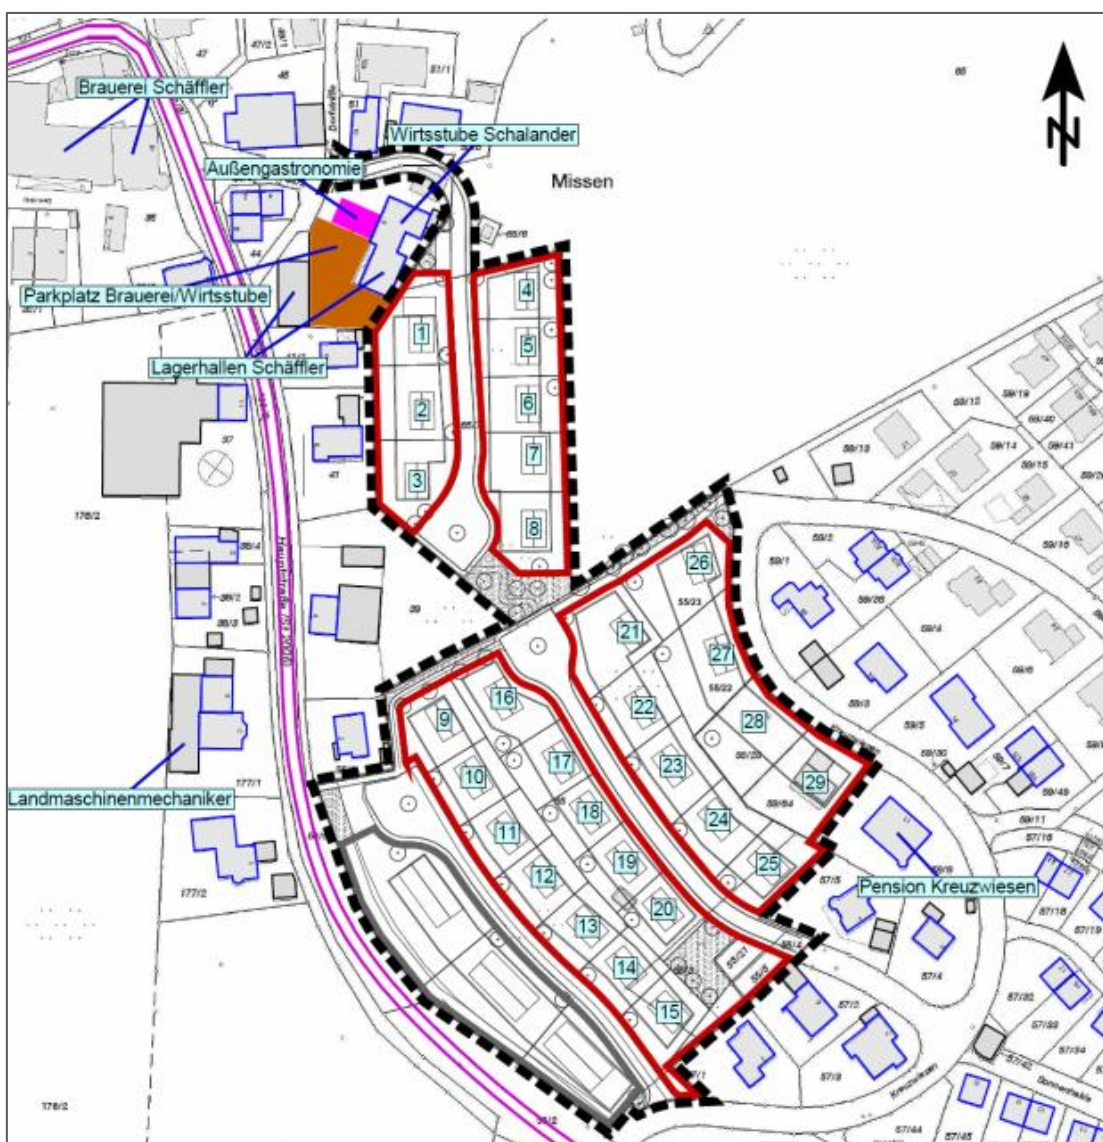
Übersichtslageplan der schalltechnischen Untersuchung (nach emplan 2016, Augsburg)
